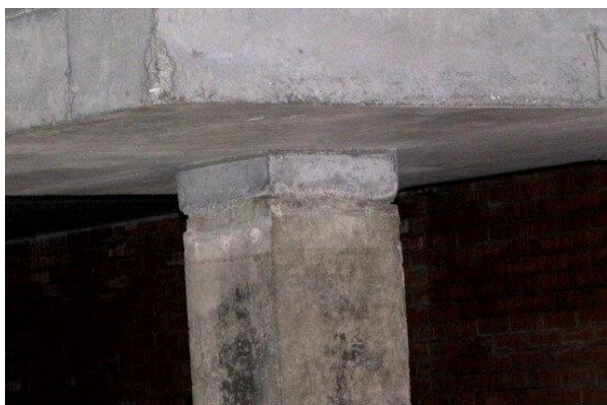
Холодный шов между этажных колонн и отслоение бетона железобетонной монолитной стены
